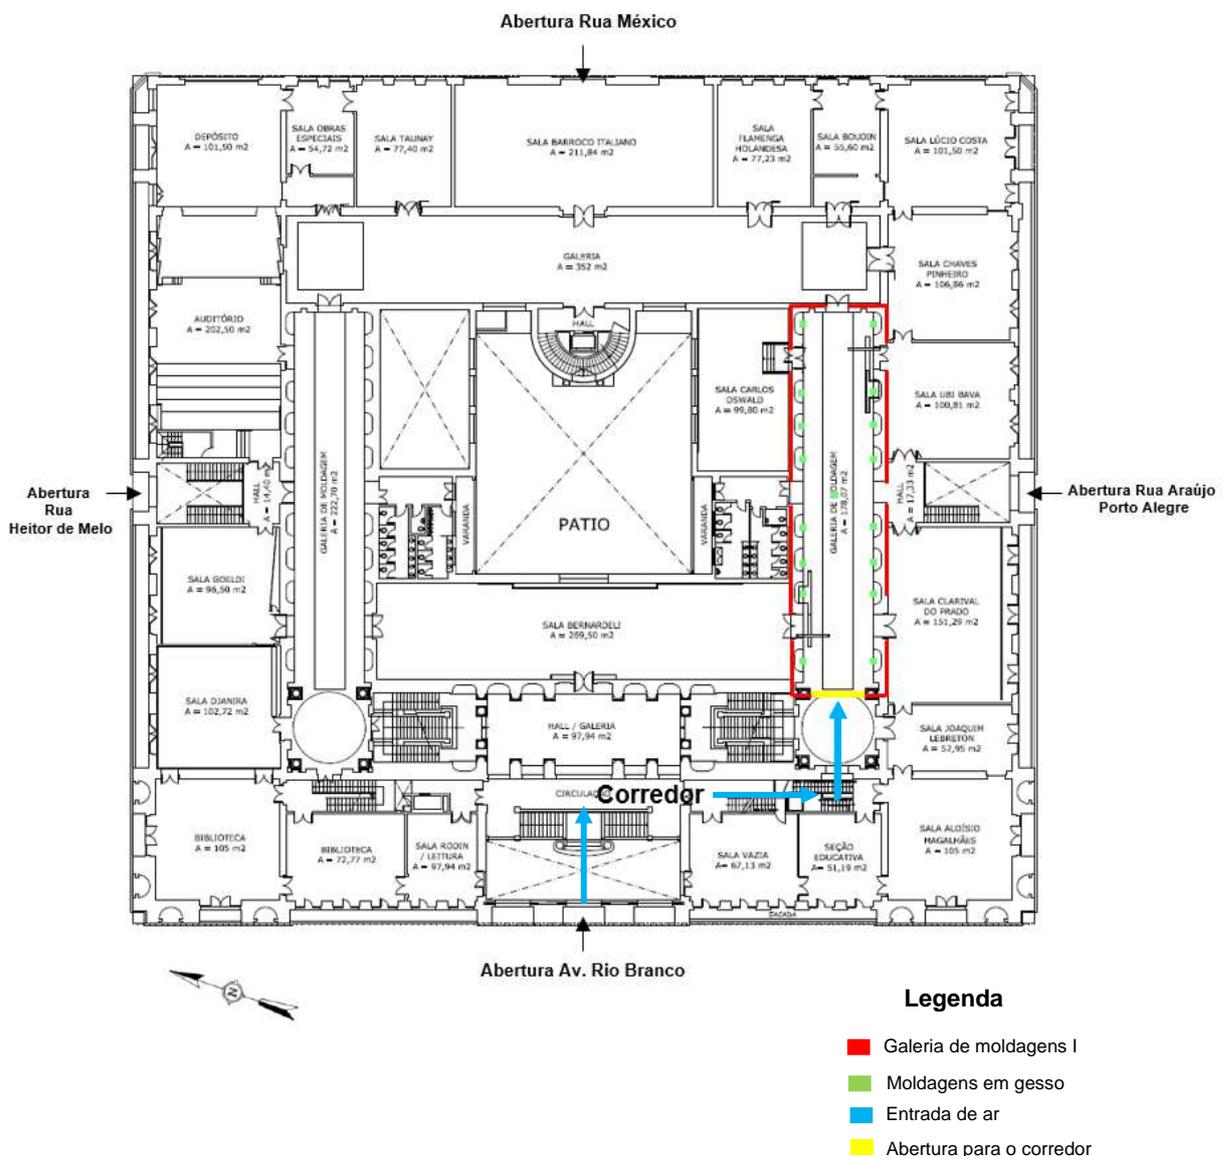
Planta baixa IV – 2º Pavimento com inserções para localização Galeria de Moldagem I, das obras, das aberturas e de fatores ambientais
